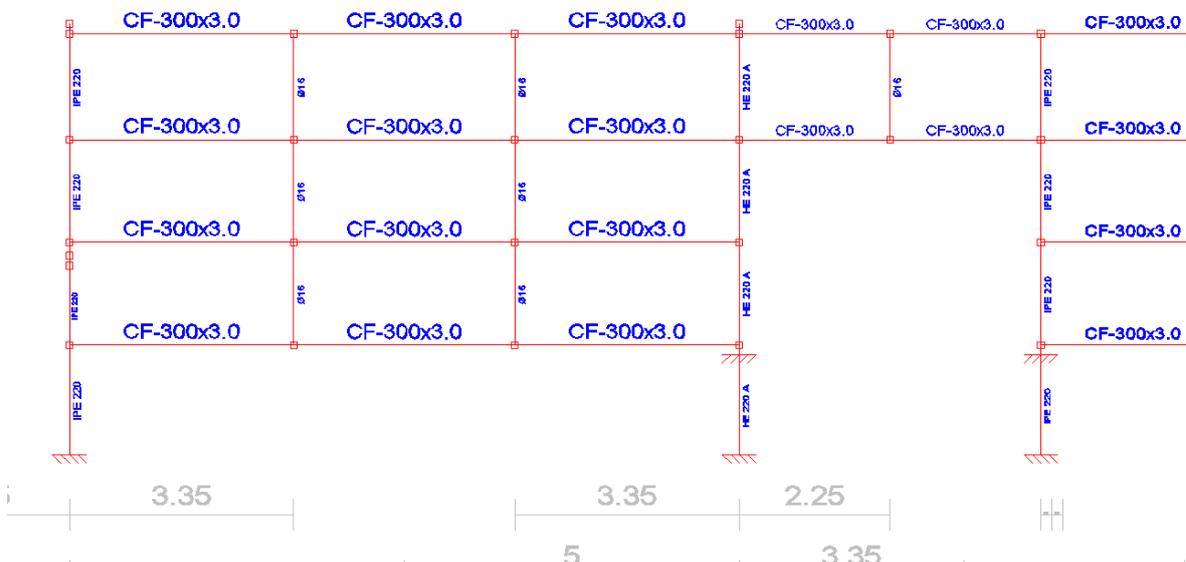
Vista lateral de la estructura de la nave con los perfiles de acero indicados
